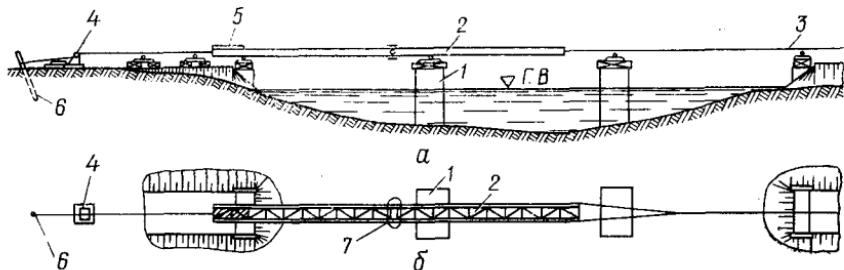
Схема монтажа металлических пролетных строений надвижкой:
